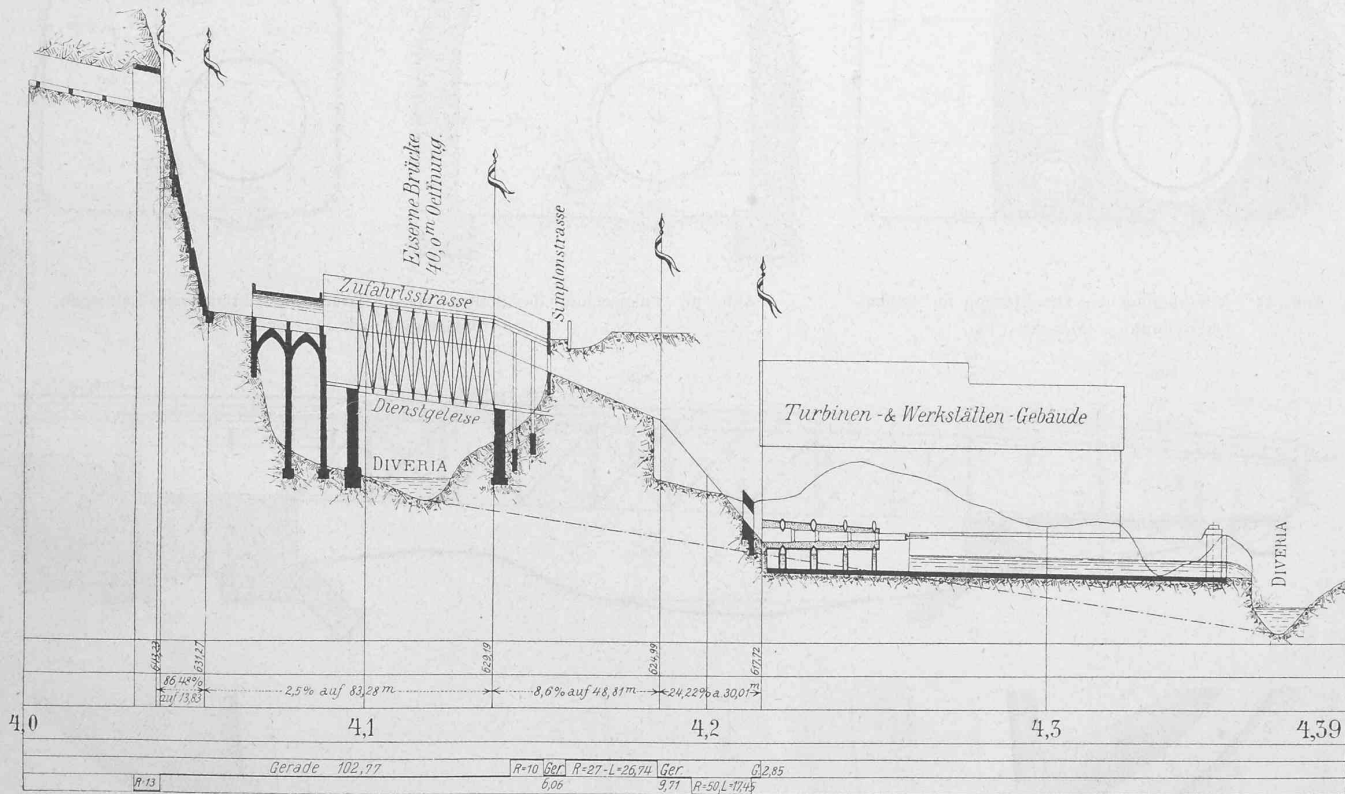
Längenprofil der Druckleitung vom Stollenausgang bis zum Maschinenhaus. Masstab für die Längen 1:2000, für die Höhen 1:400.
